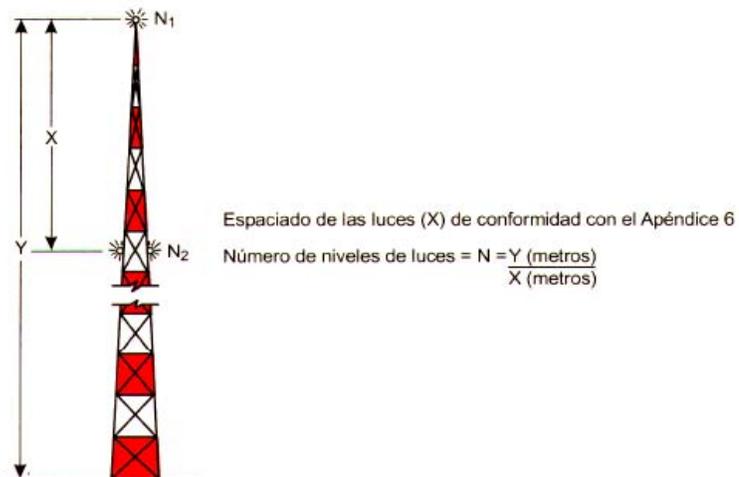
Ejemplo de señalamiento e iluminación de estructuras elevadas
